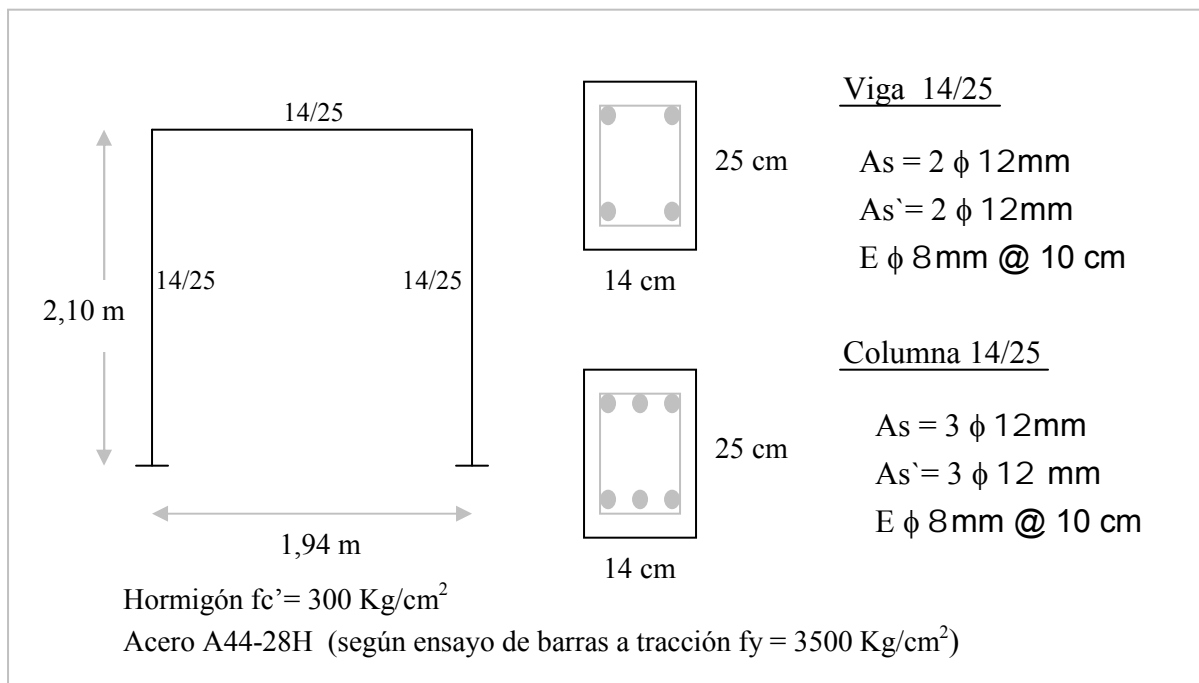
Dimensiones y Armado de las Secciones del Pórtico
